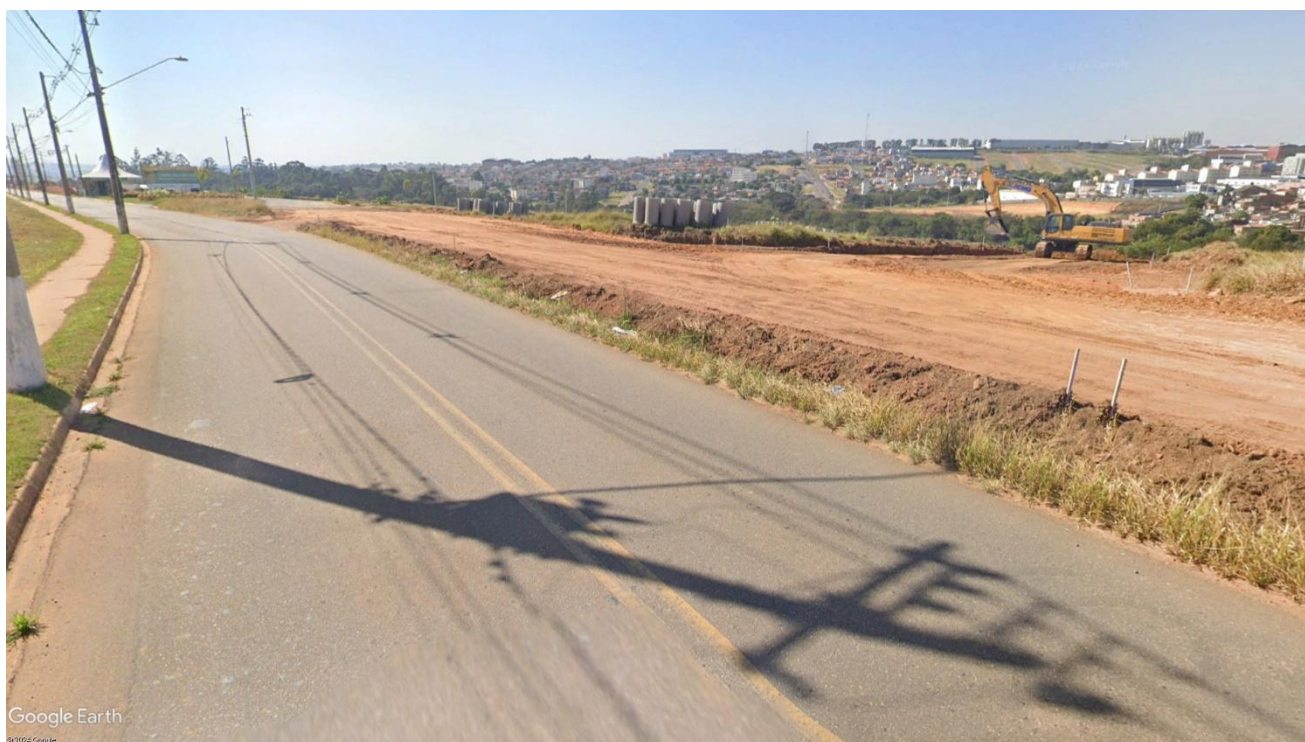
Infraestrutura – Estrada Municipal Vicente Teles de Miranda BTV
